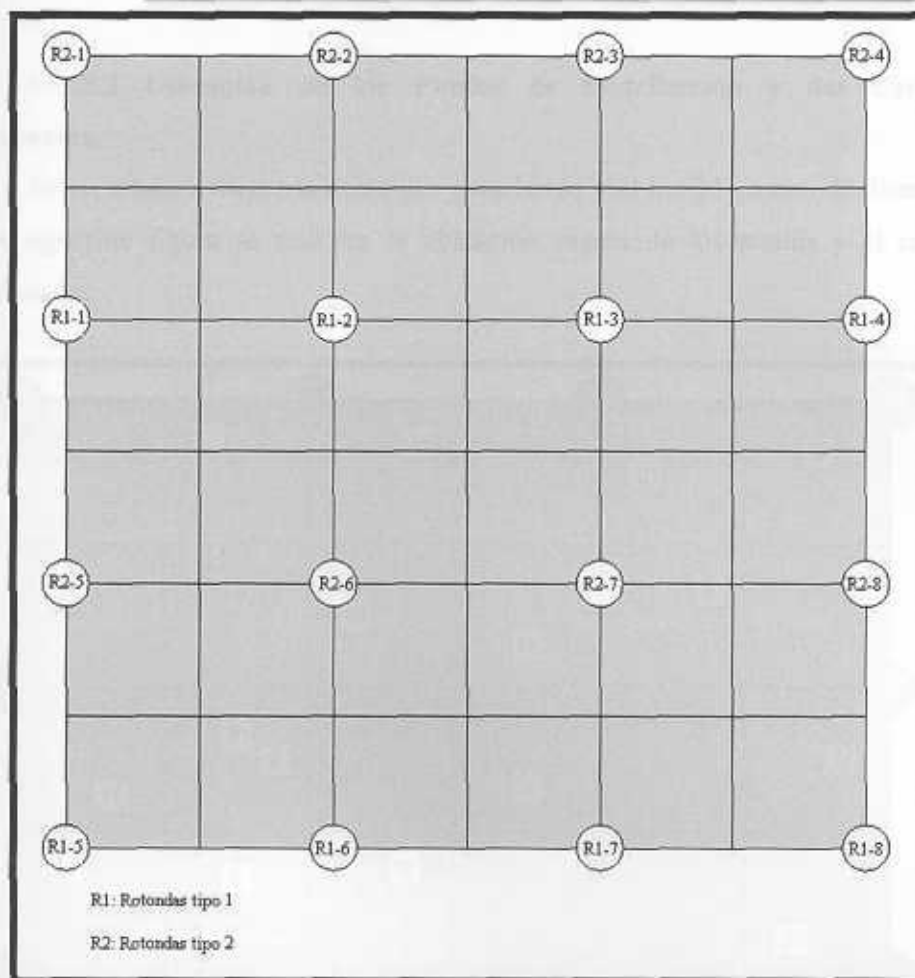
Ubicación de las rotondas en la red vial propuesta.
